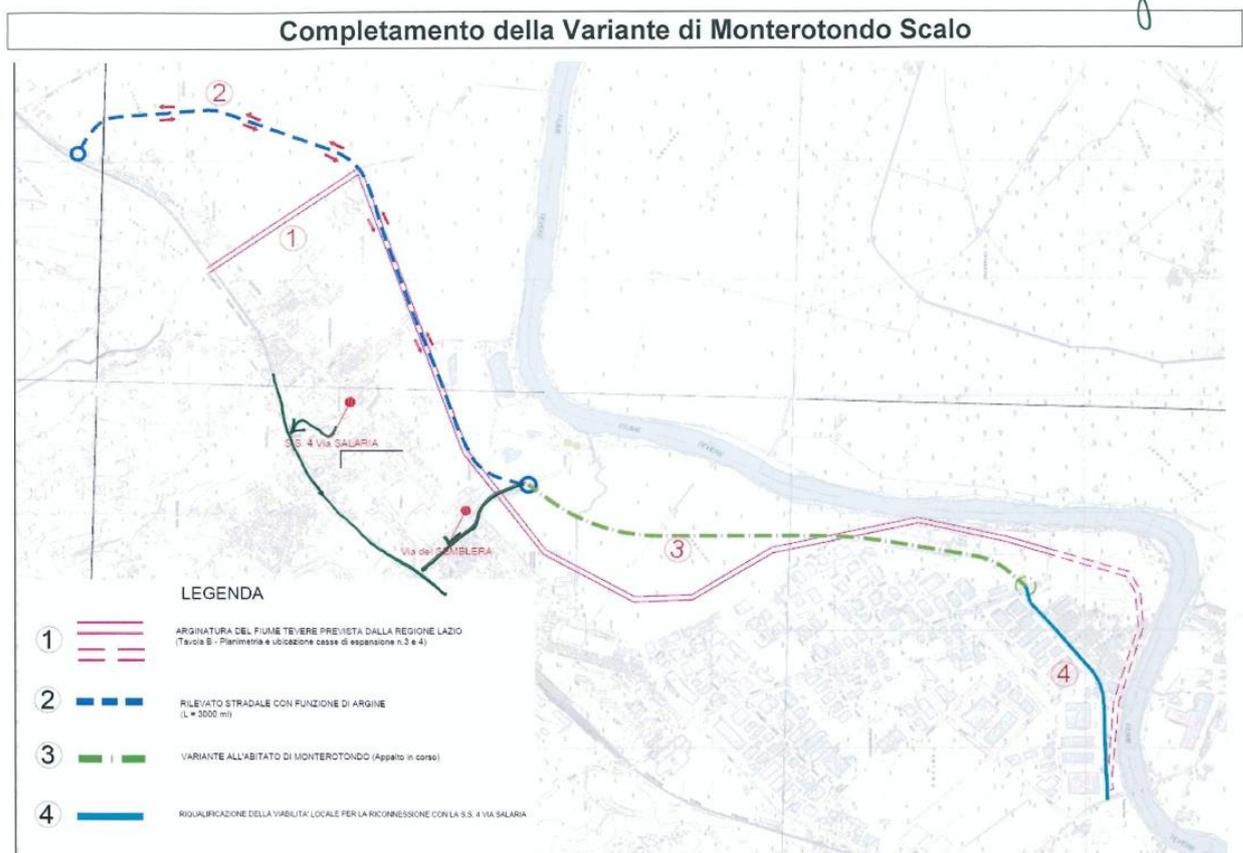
Planimetria allegata alla documentazione del Compartimento
